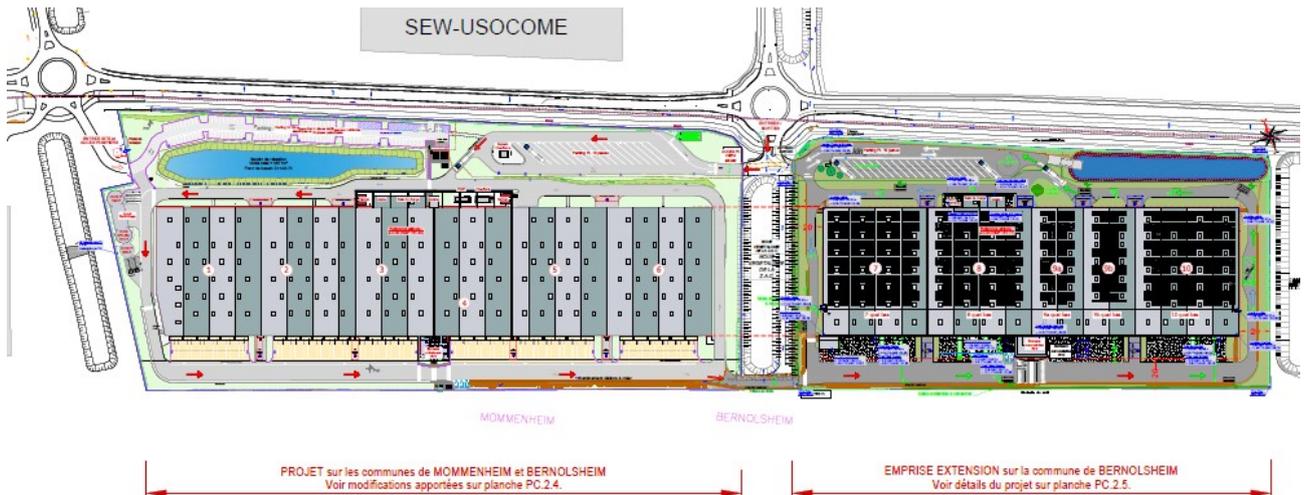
plan du site existant (à gauche) et de l'extension (à droite)
